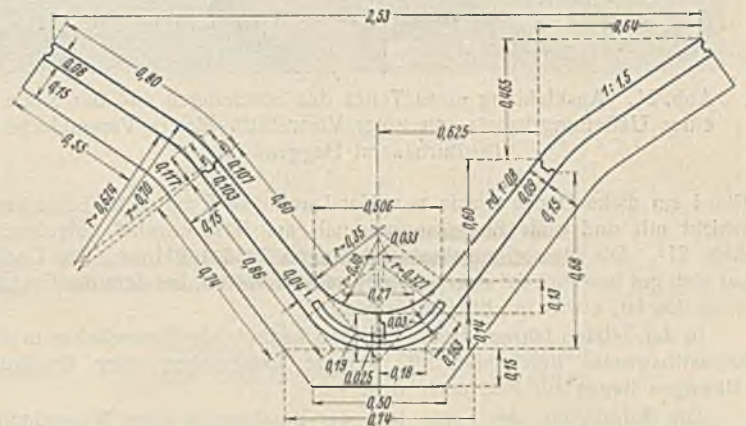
Querschnitt der Betonschalen- und Plattenauskleidung (Stellprofil) eines Baches im Industriegebiet (Emschergerossenschaft, Bauamt Essen).
